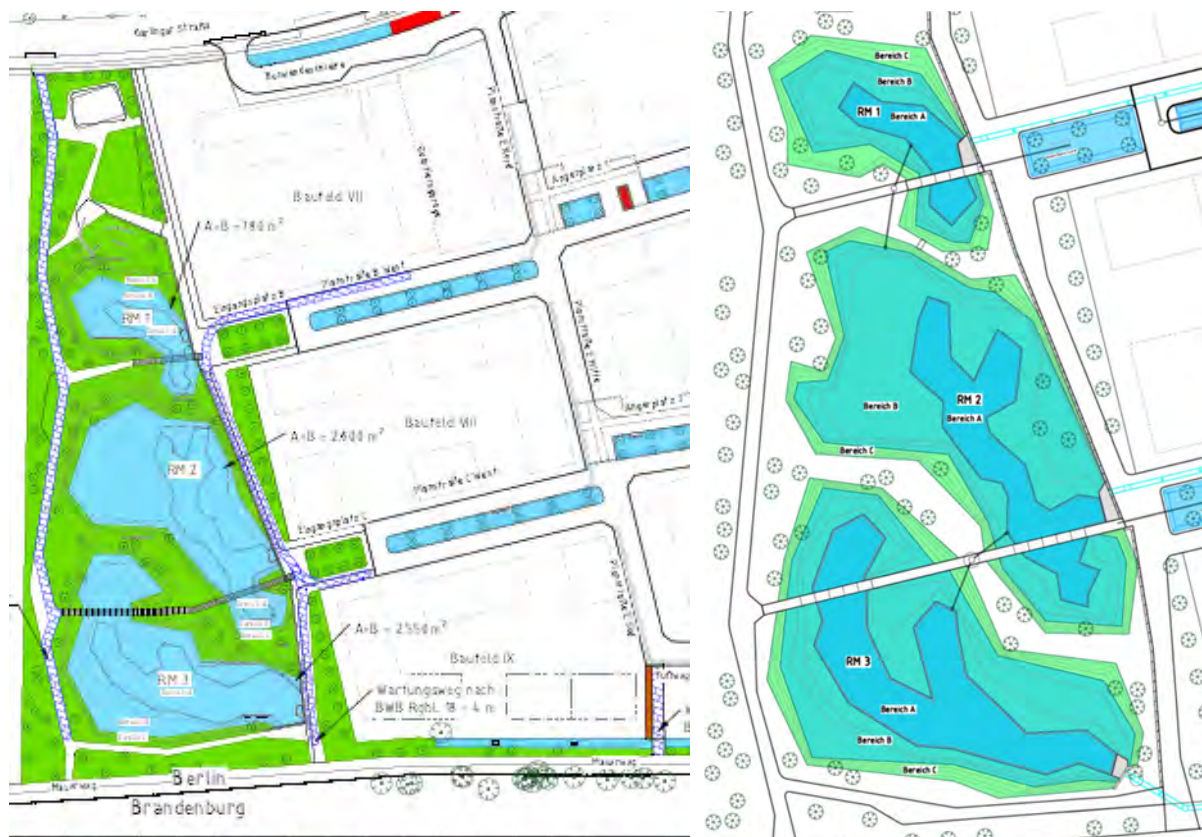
Bauentwurf Regenwasser, Lageplan / Zonierung Versickerungsbereiche und Retentionsraum (Stadt und Land /IPS/BWB)
